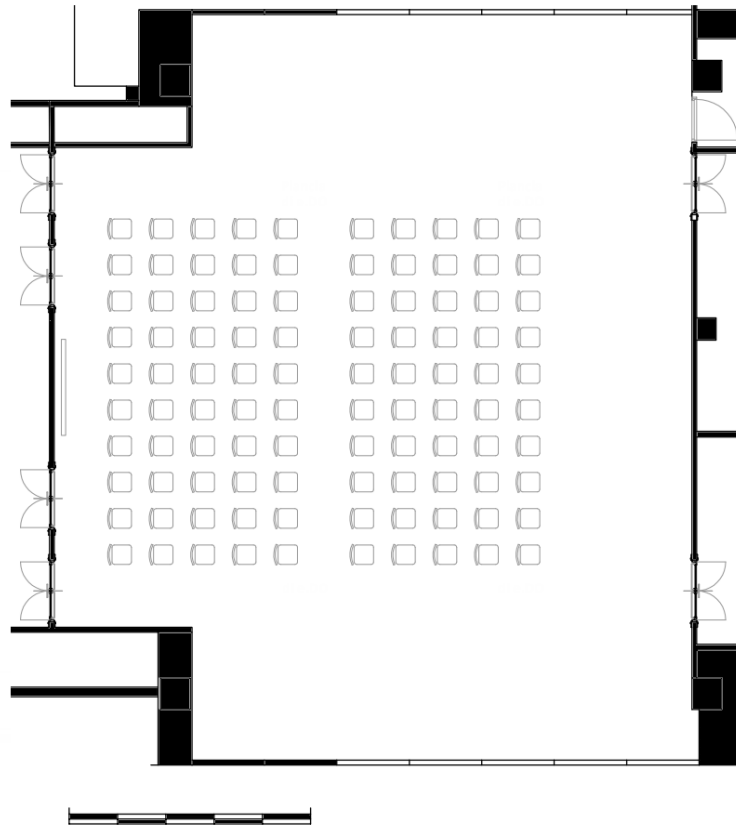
Planimetria dell'Auditorium di Fondazione Agnelli
